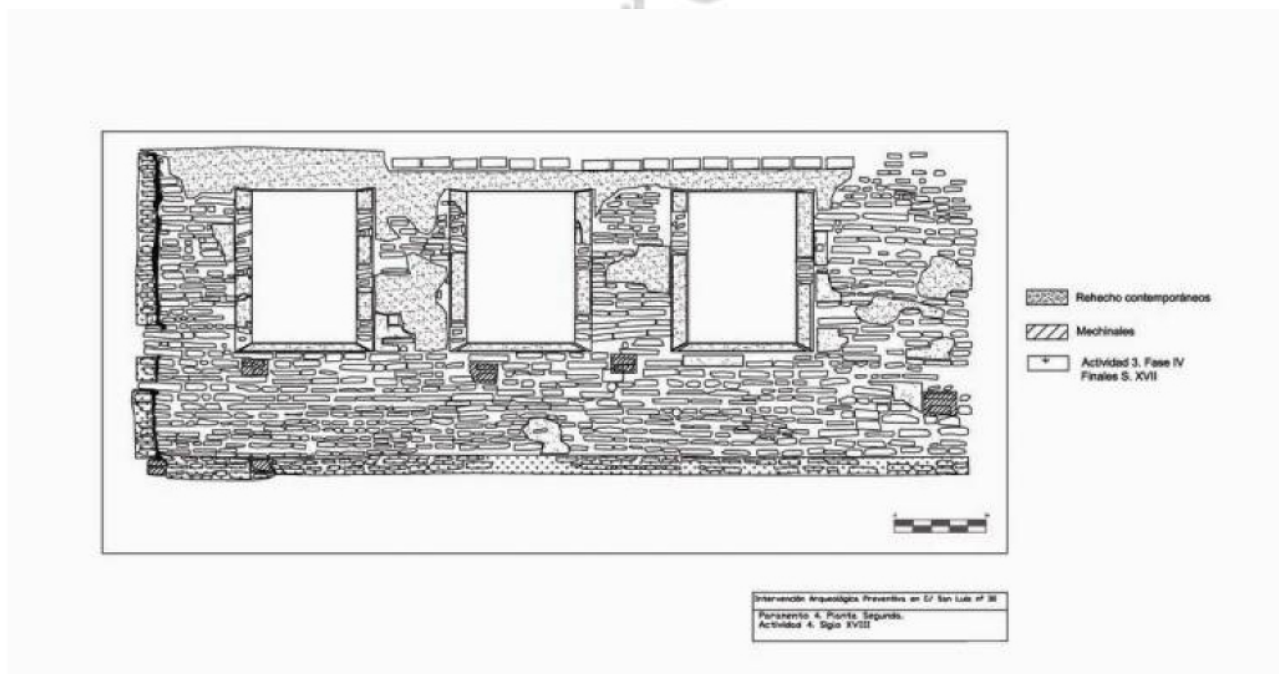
Alzado de cara interna de fachada en 2ª planta. S. XVIII
